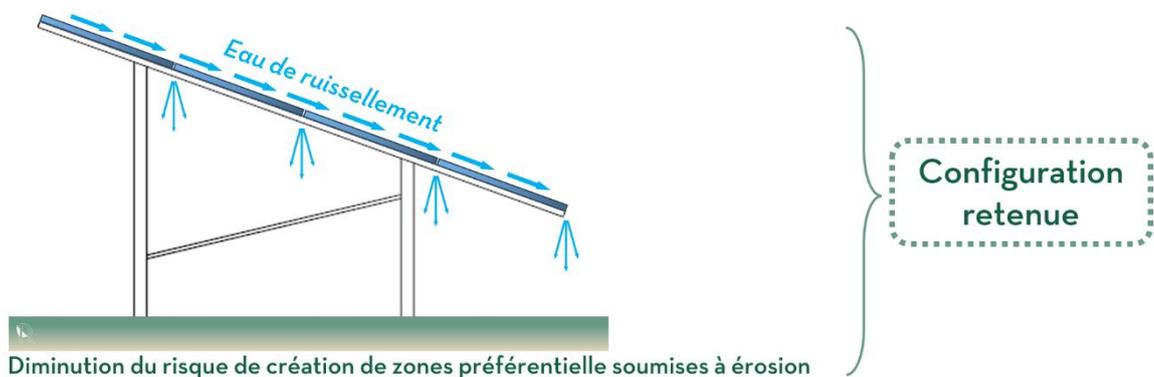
Schéma de principe des structures et ruissellement eau pluviale sur les panneaux
